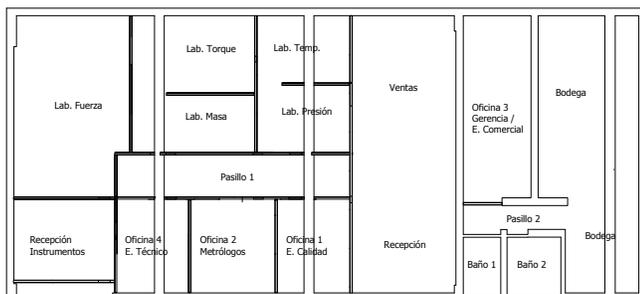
Planimetría Propuesta de nuevas instalaciones Certec Ltda. para corrección. Elaboración Propia.
